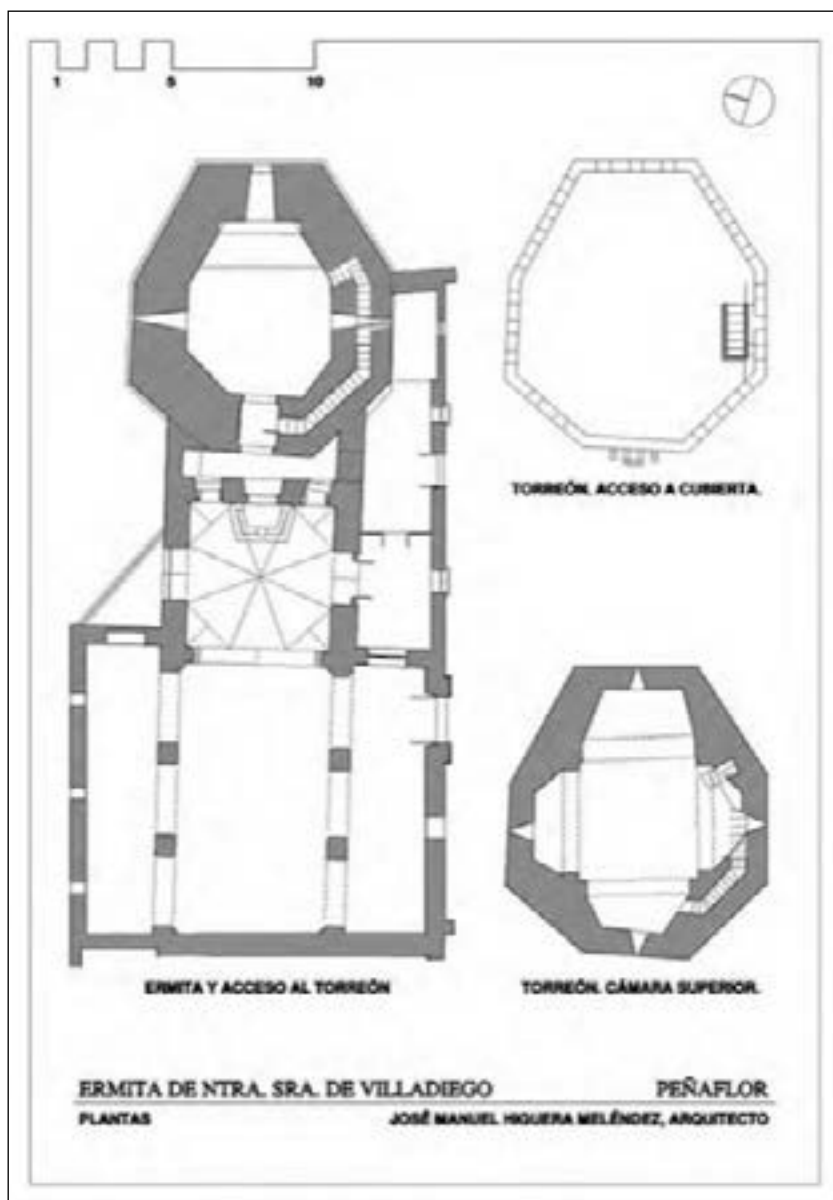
Planta de la ermita de Ntra. Sra. de Villadiego (Peñaflores, Sevilla).
